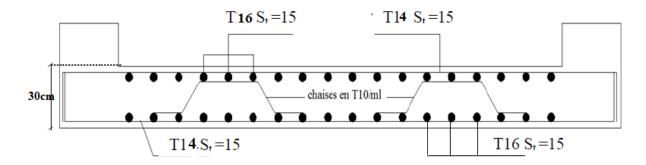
Ferraillage de Radier Nervuré d'après ce dessin.
